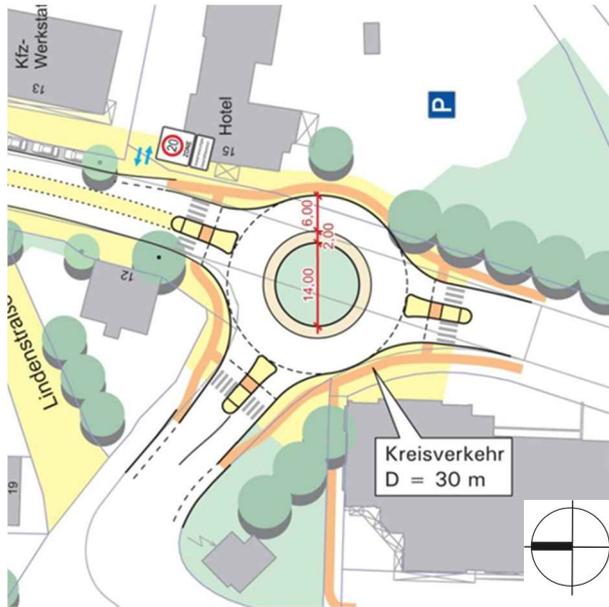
Kreisverkehr Kirchenstraße/Adolfstraße
